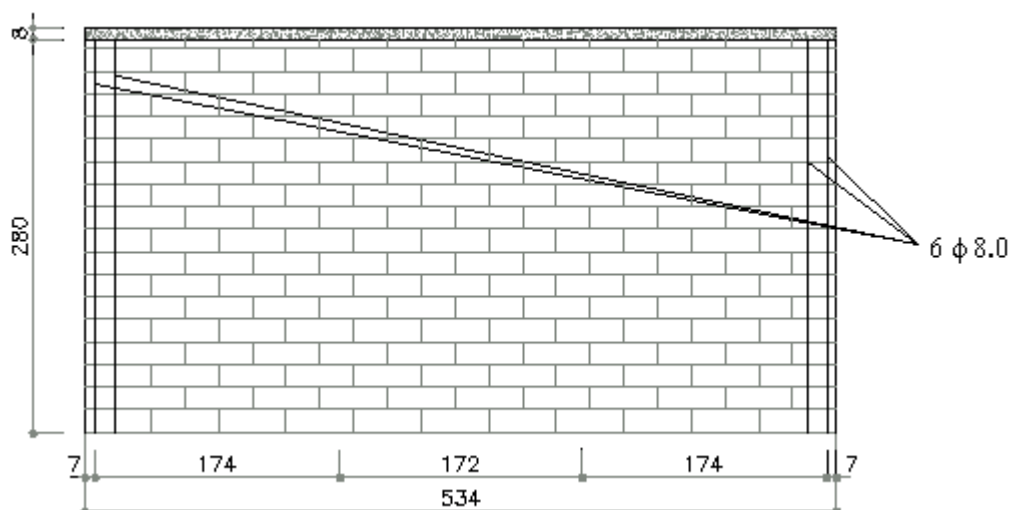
Detalhamento das armaduras de flexão nas paredes PY13/PY14
